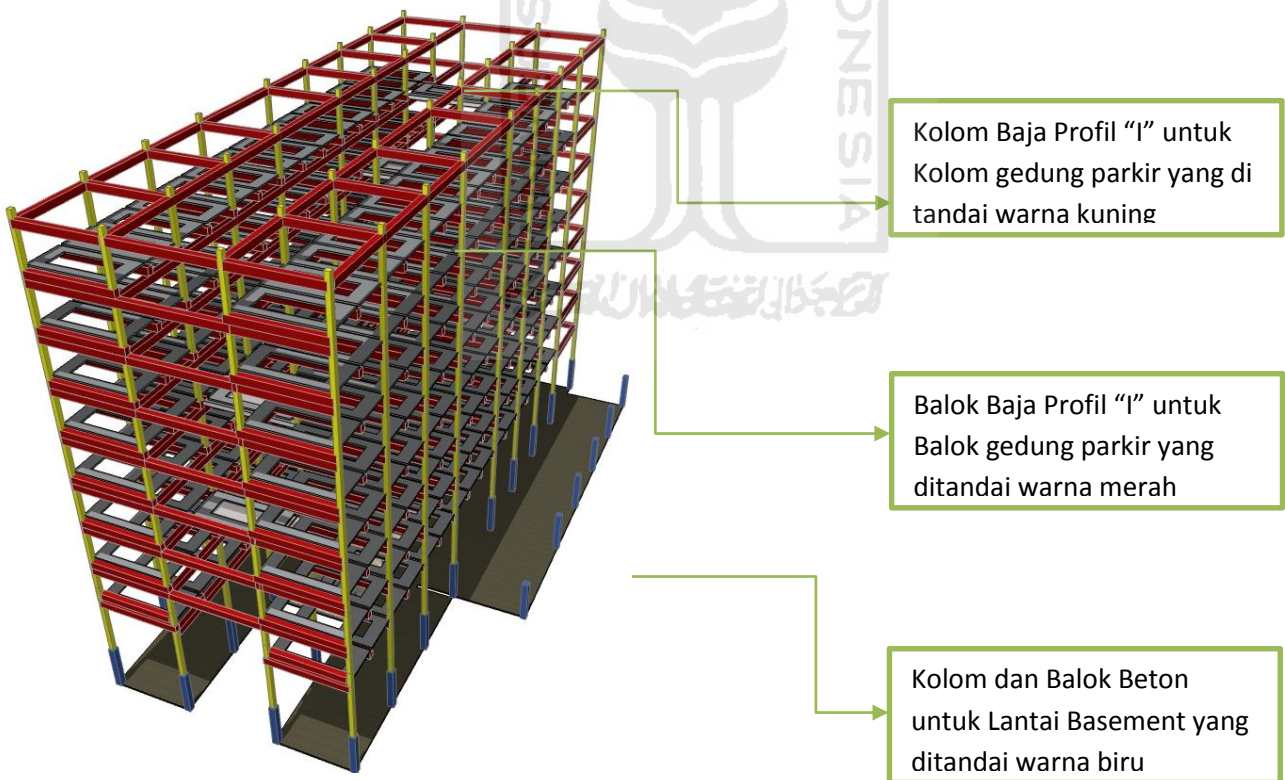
Rencana struktur lantai basement (sumber: analisa penulis)
